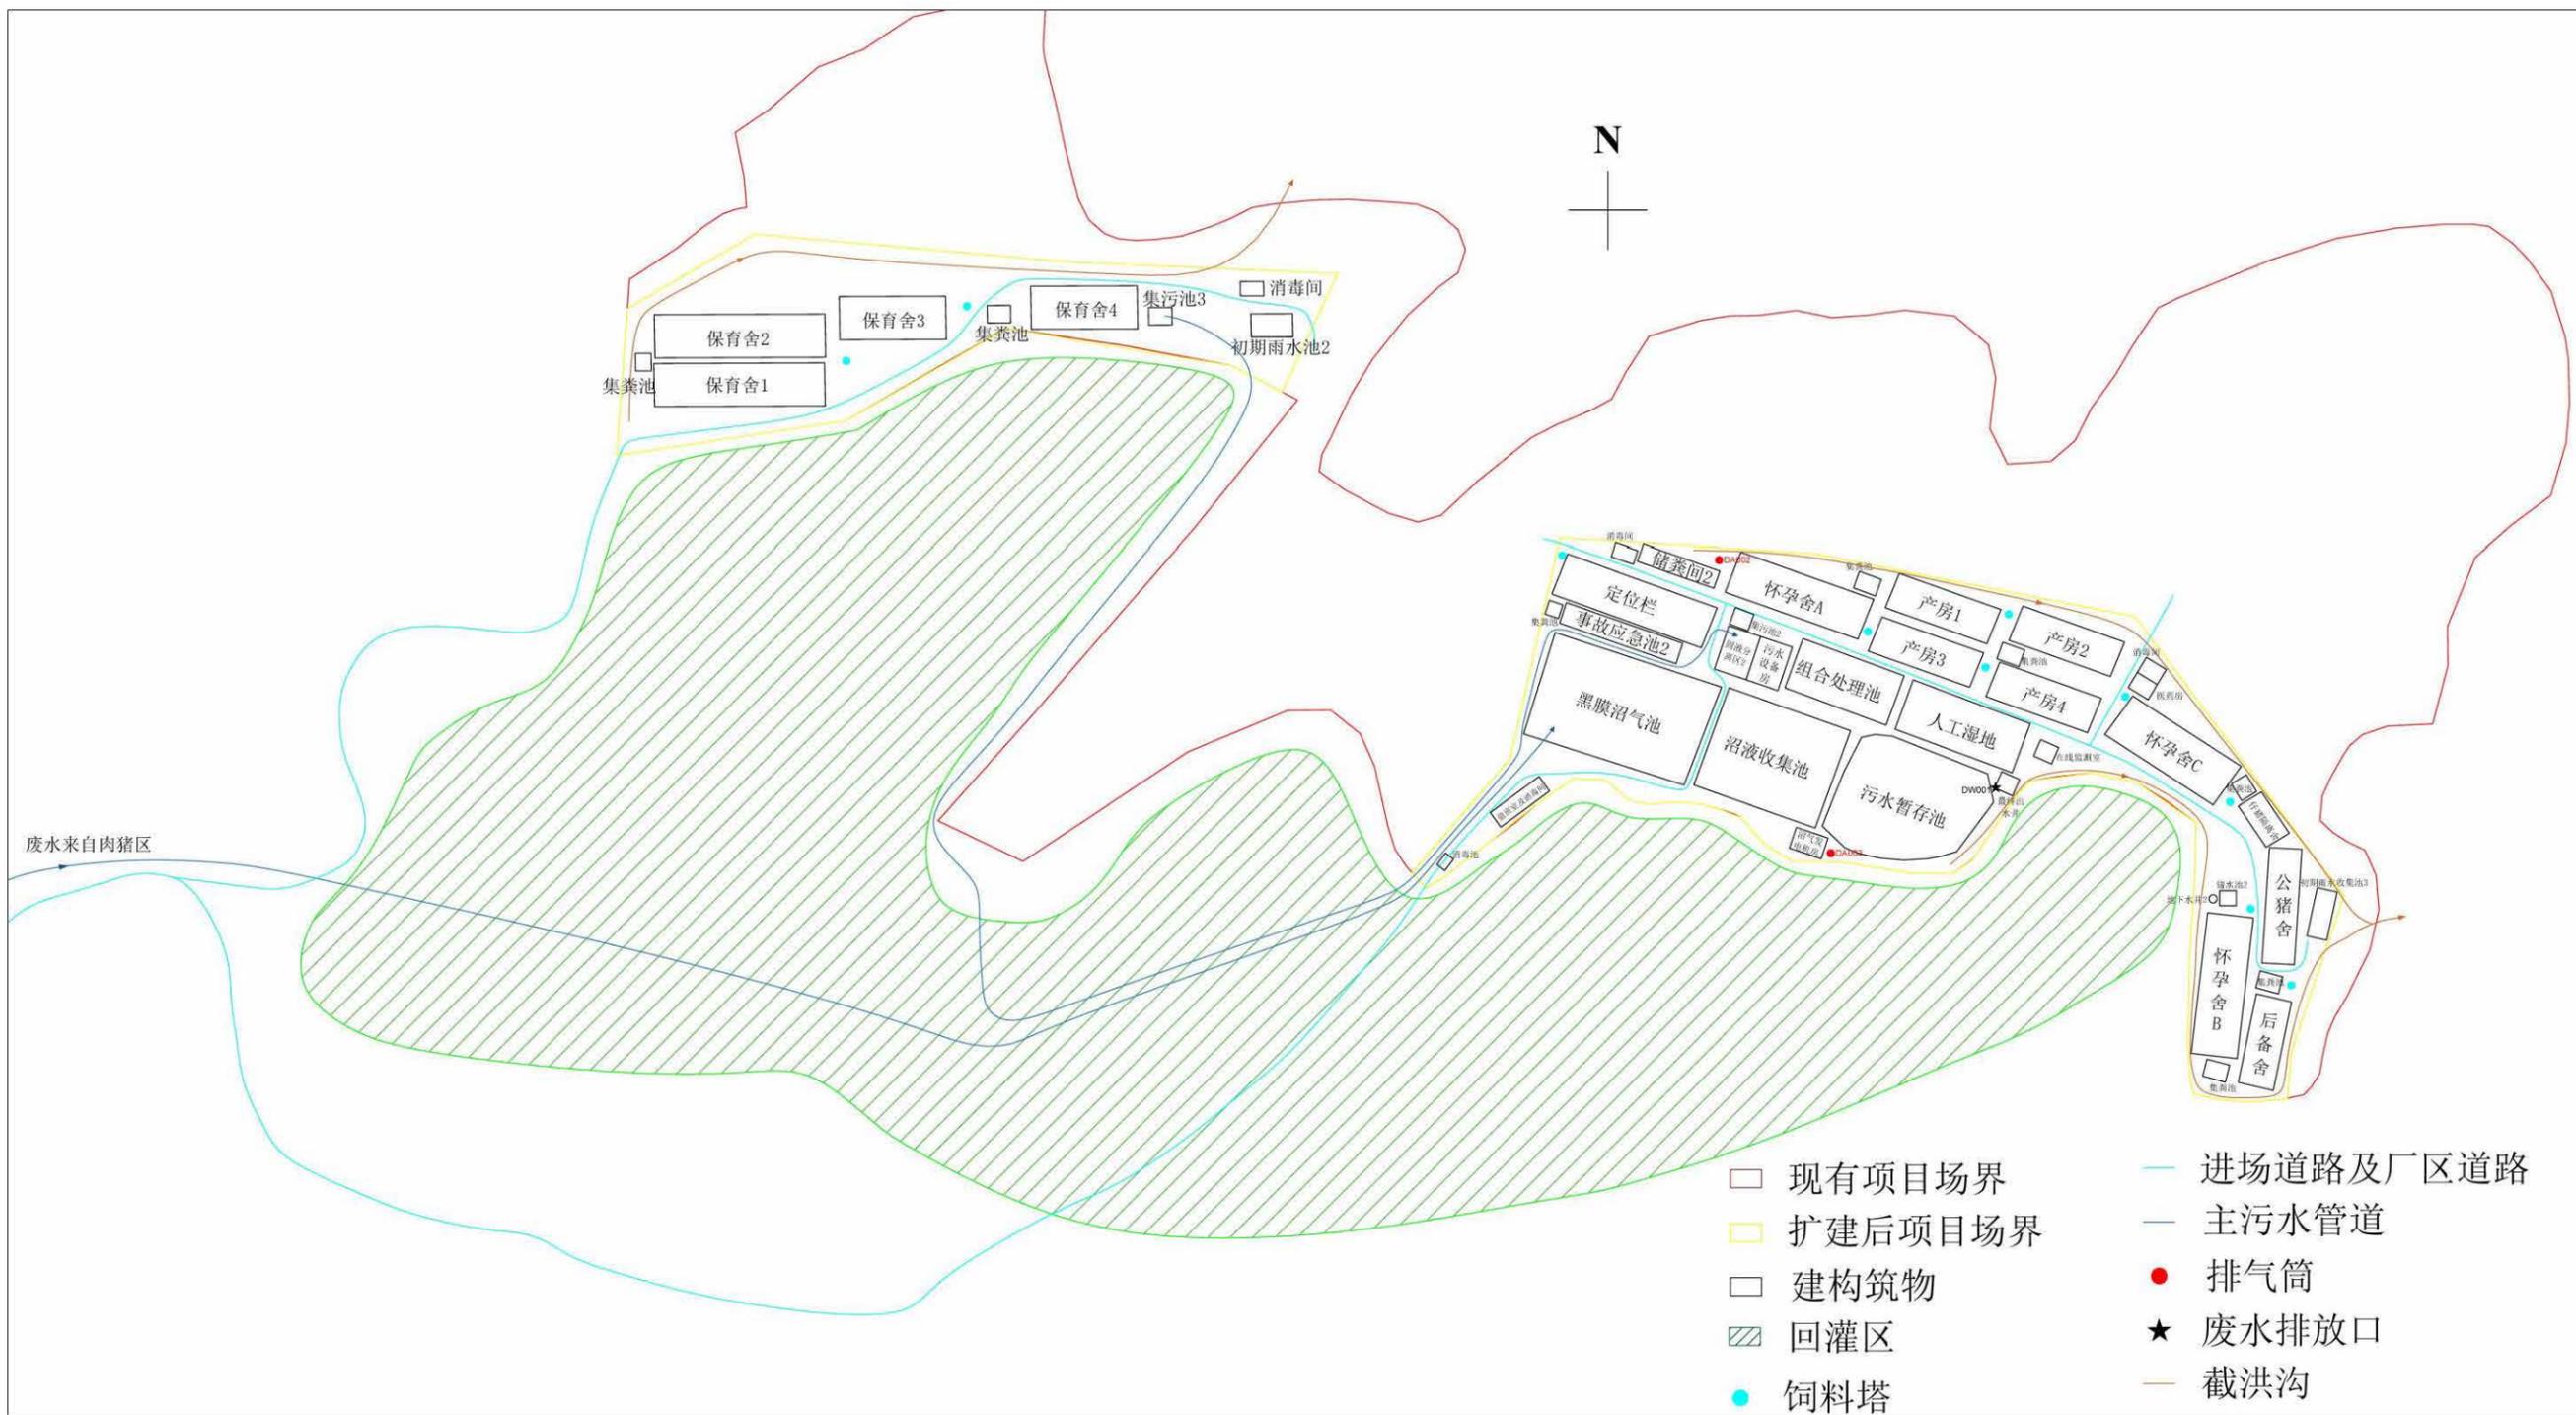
项目平面平面布置图 (保育区+母猪区)
